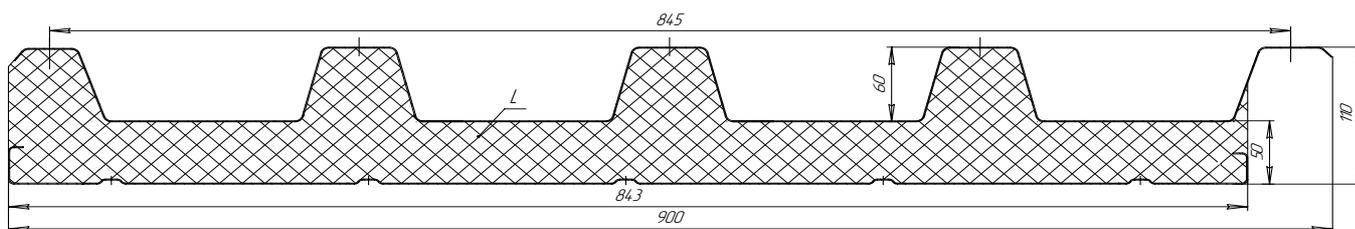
Панель трехслойная кровельная с монтажной шириной 845 мм
